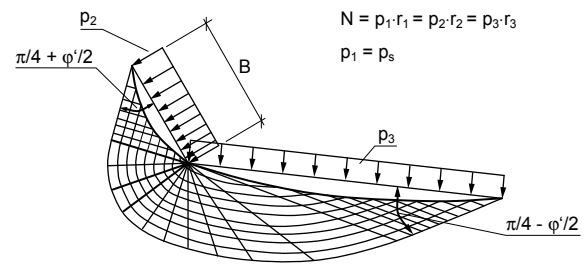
Belastung und Bruchfigur beim Grundbruch im Ulmenbereich gemäß (GLOCK, 1976)
